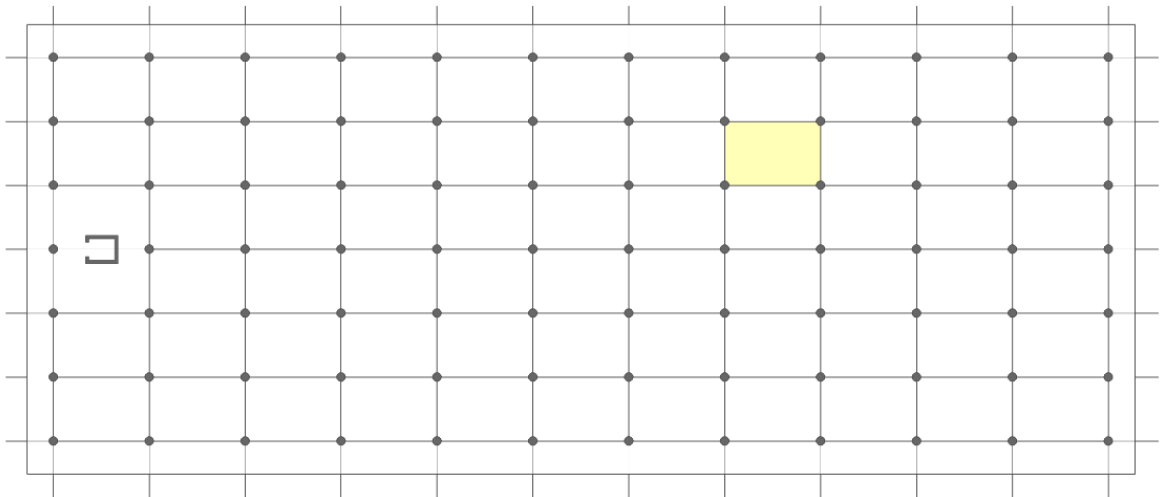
Planta estructural. Módulo estructural: 6m x 9m. Fuente: autor
